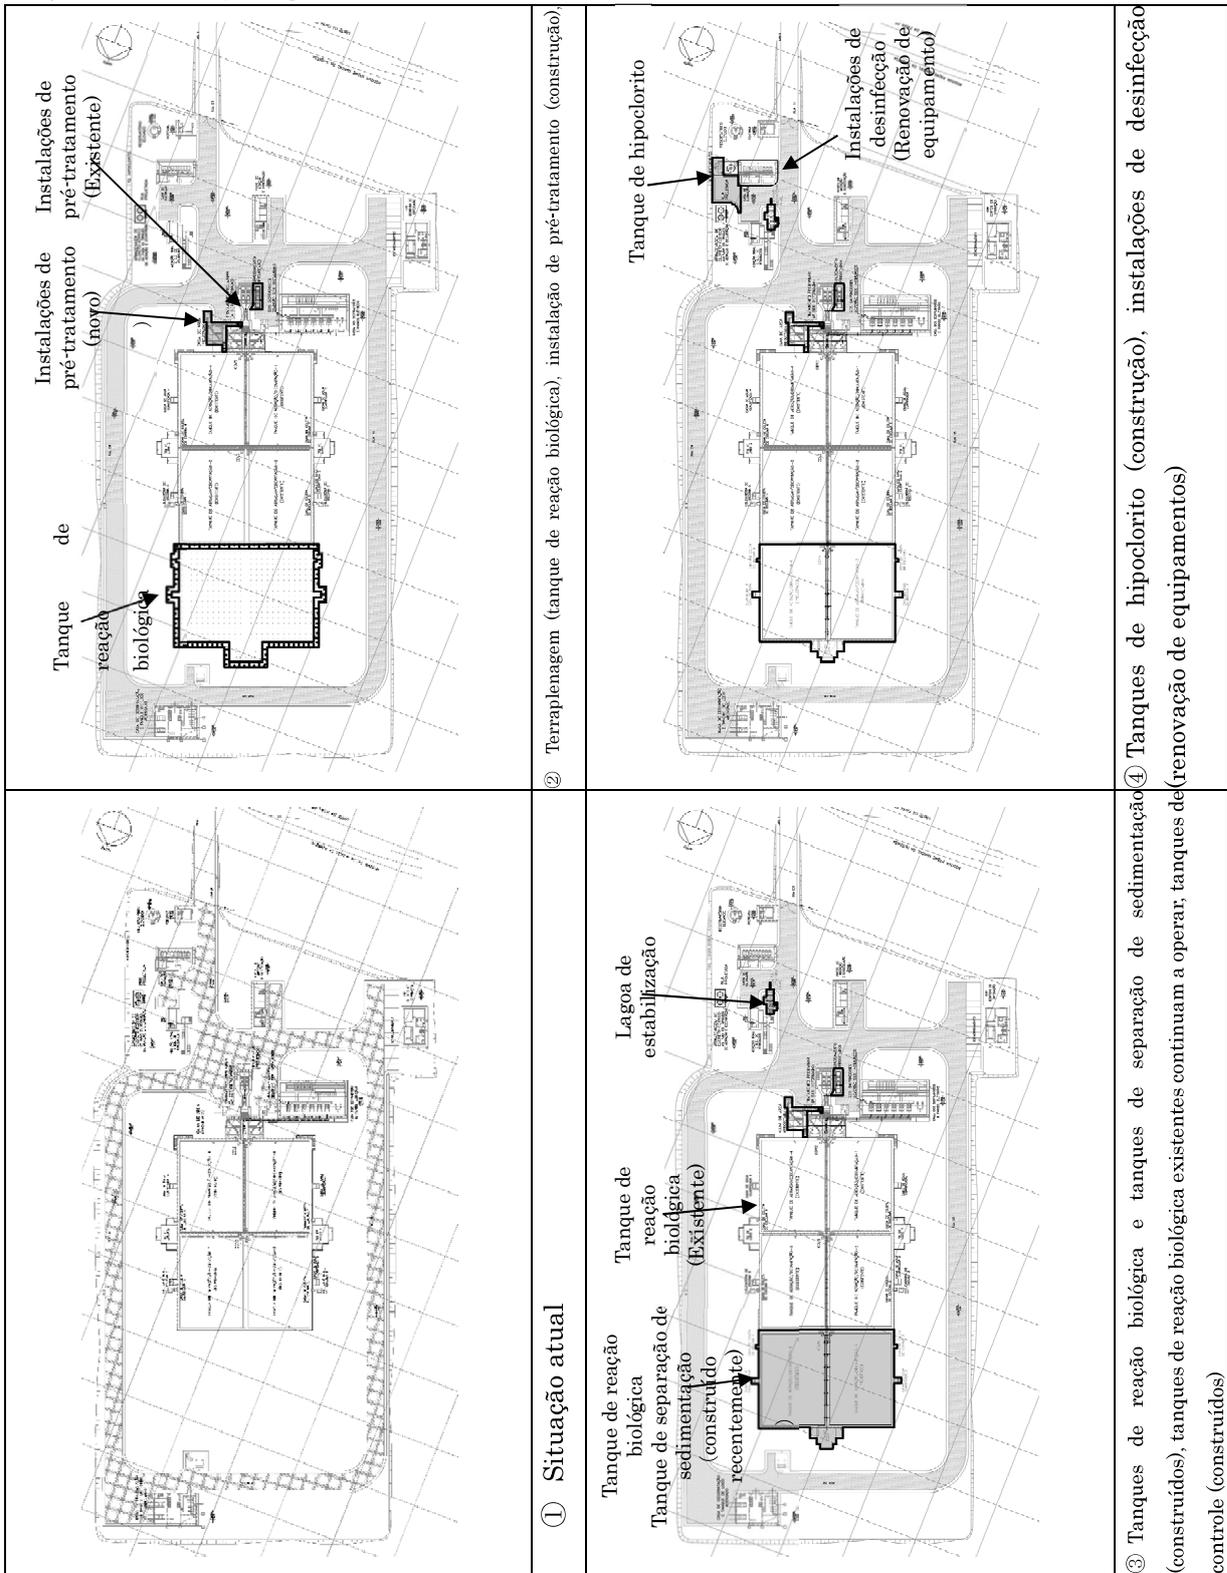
Etapas de construção da planta de tratamento P2 (1/2)
